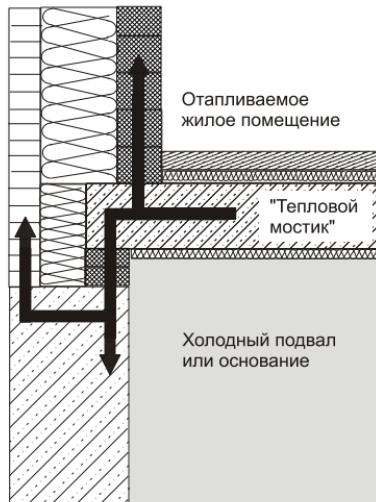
"Тепловой мостик" в месте стыка полой наружной стены с подвальным перекрытием и подвальной стеной или с плитой основания и фундаментной стеной
